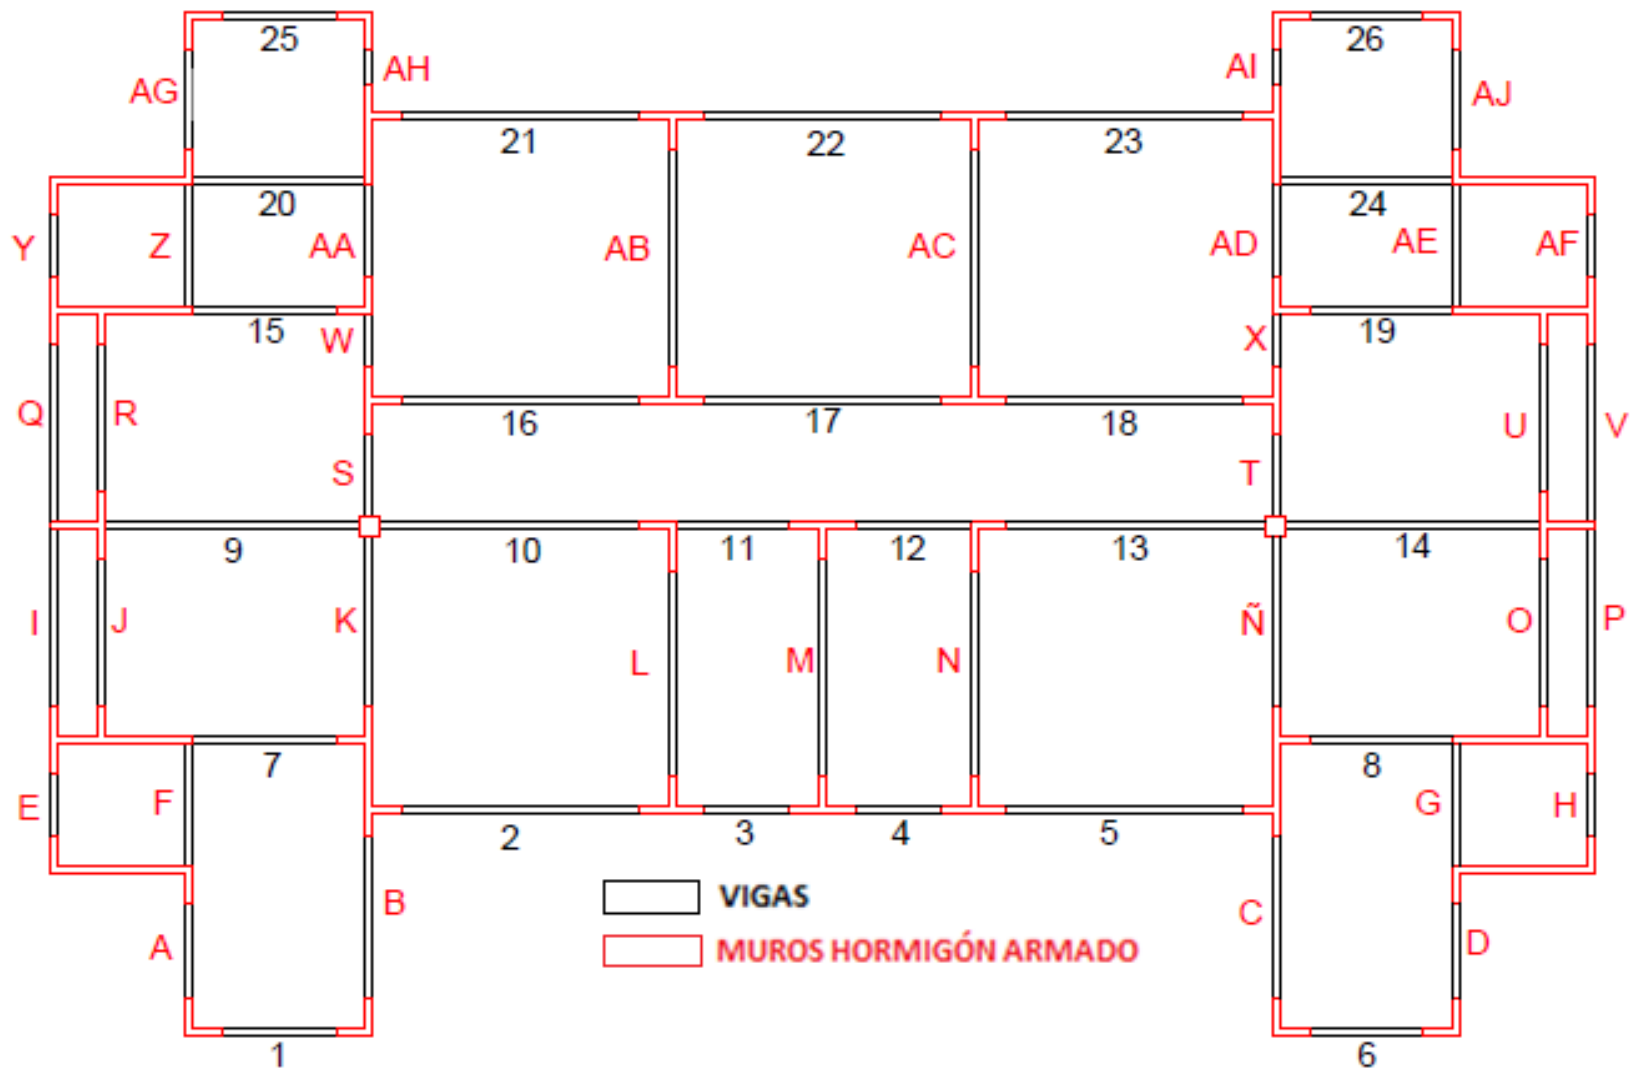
Vista en planta, Losa Proyecto Condominio Parque El Volcán.
